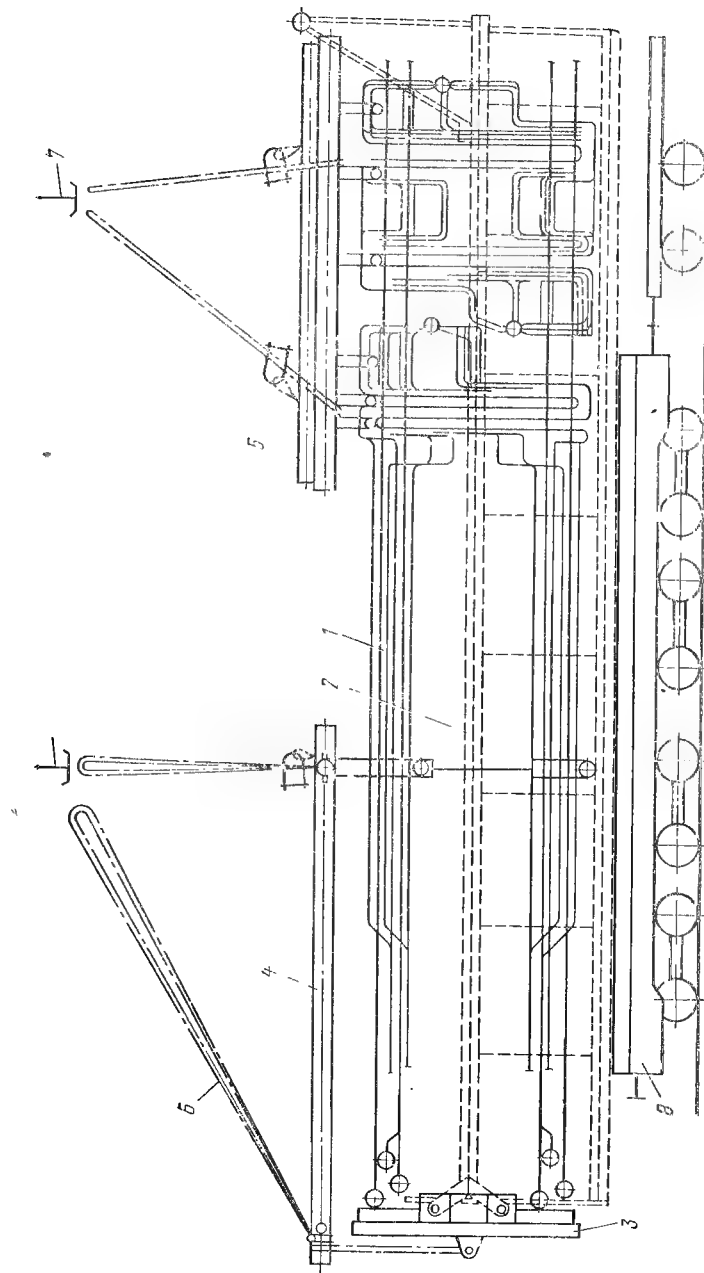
Схема строповки при погрузке блока конвективной шахты. 1 — монтажный блок конвективной шахты; 2 — приспособление — контейнер для транспортировки и монтажа блока; 3 — приспособление для транспортировки и монтажа блока; 4 — траверса-распорка; 5 — рама монтажная; 6 — рама монтажная; 7 — стропы; 8 — крюк грузоподъемностью 200 т; 9 — железнобетонная платформа грузоподъемностью 200 т.
